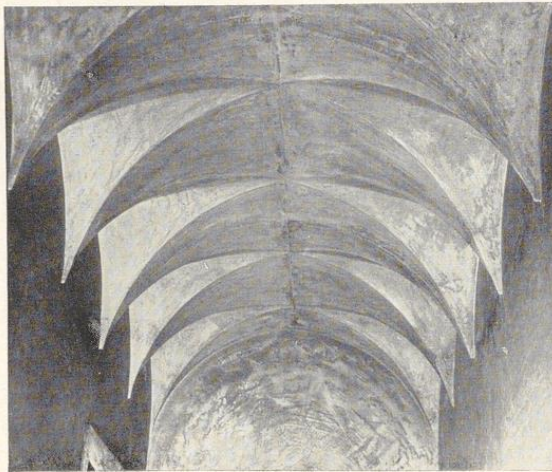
Rundeseisenkonstruktion für eine Stichkappe am Spiegelgewölbe
